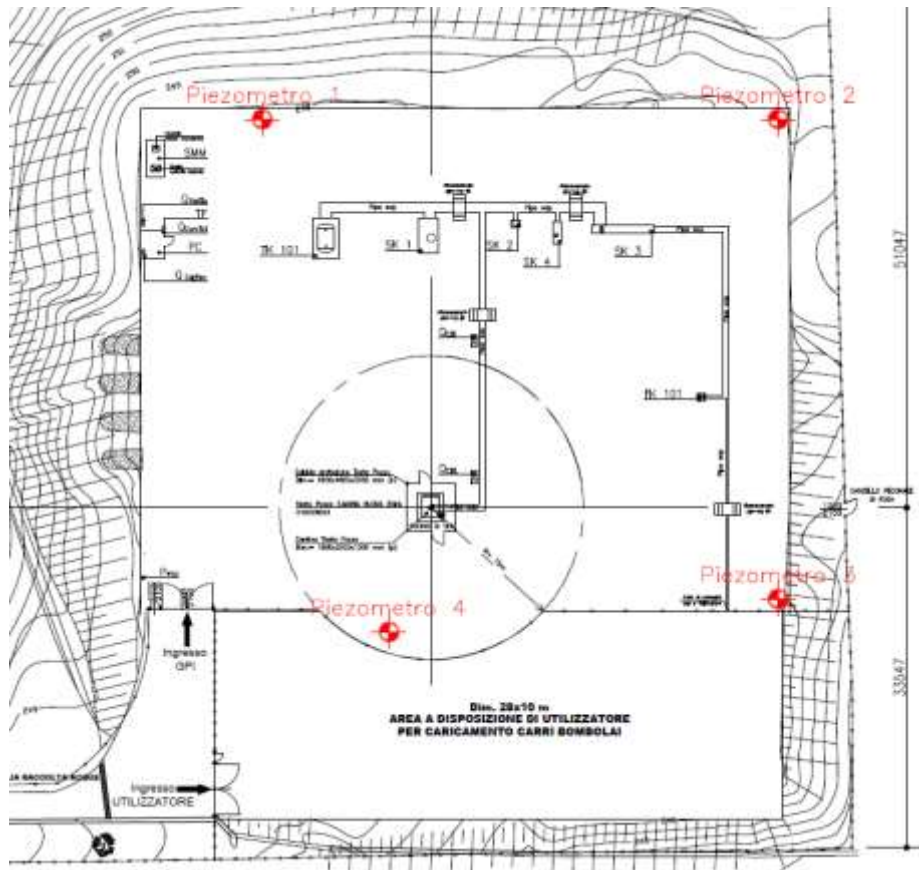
estratto planimetrico Tavola 1 Planimetria di progetto e posizionamento piezometri di monitoraggio allegata al Piano di monitoraggio della componente idrica depositato
